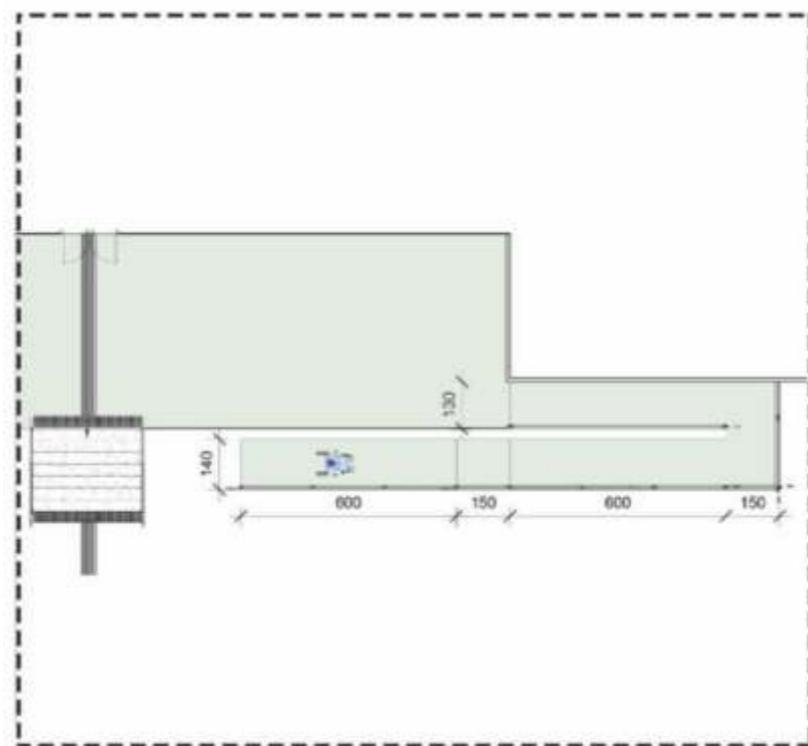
Planimetria e vendosjes së rampës me përmasat sipas normave të U.A. 33/2007. Paraqitja e vendosjes së taktoreve për të verbër te shkallët e ndërtesës
